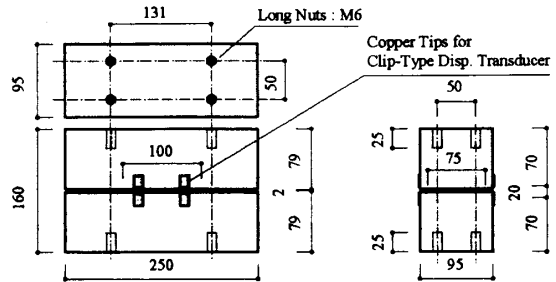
せん断ひび割れ試験体の詳細 (単位mm)
